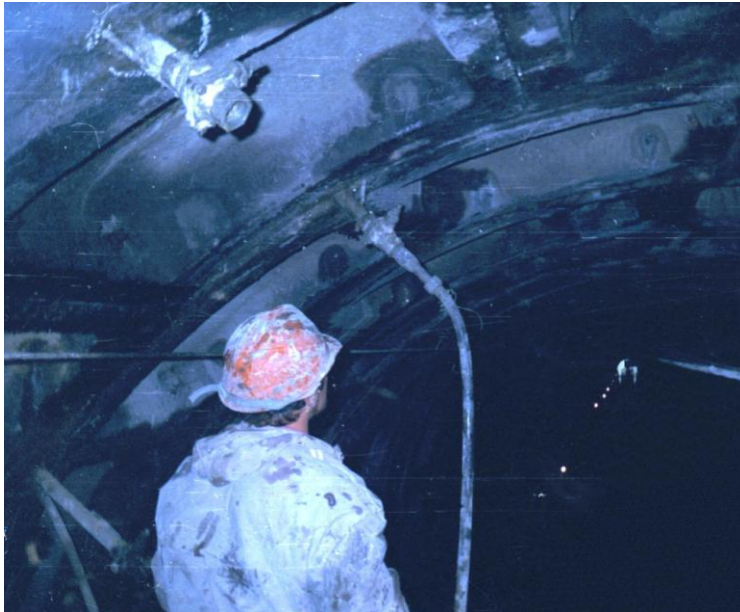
Кріплення опалубки за допомогою шпильок
